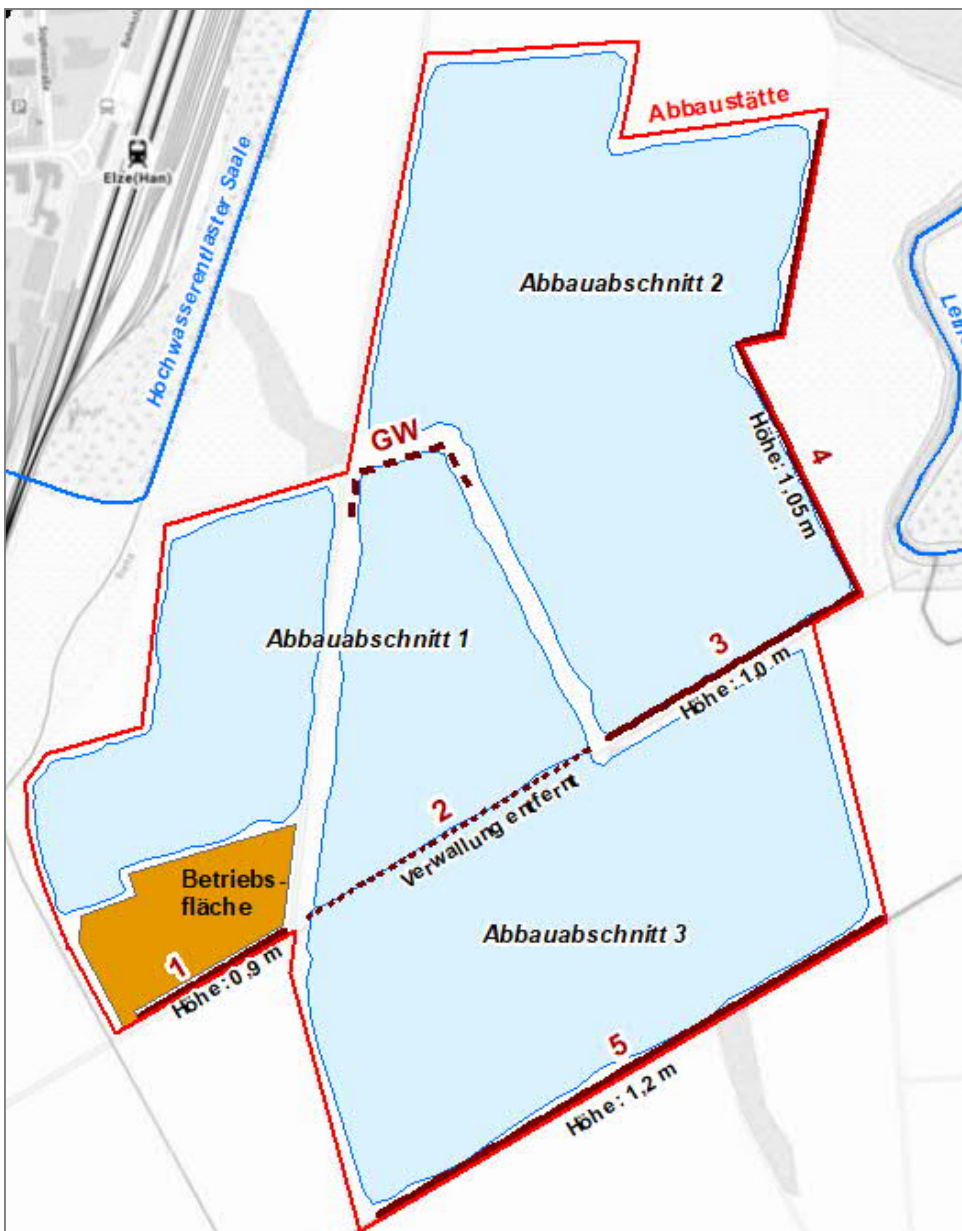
Lageplan Verwallungen Abbauabschnitt 3
